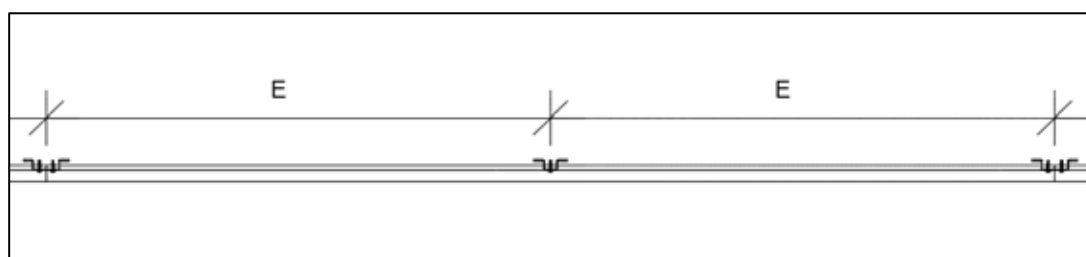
Coupe horizontale du système de ventelles avec ossature secondaire type OMEGA.
